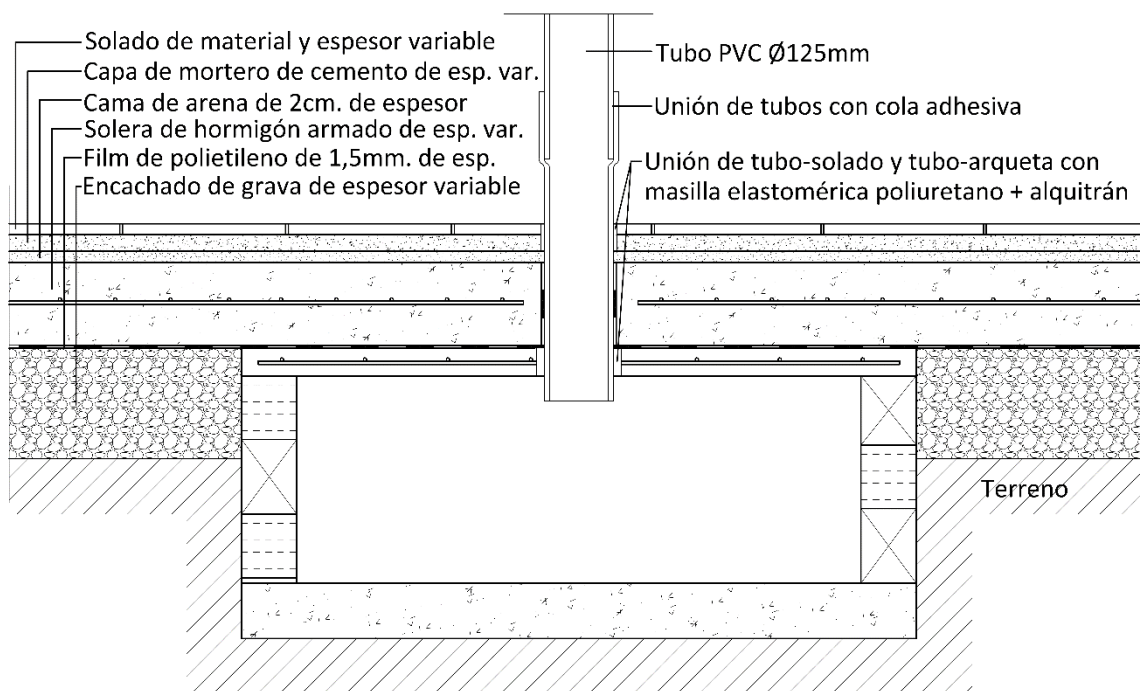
Sección B-B', detalle de arqueta de captación (SUMP) colocada bajo la solera de hormigón, cotas en metros y escala 1:15. (Elaboración propia).
